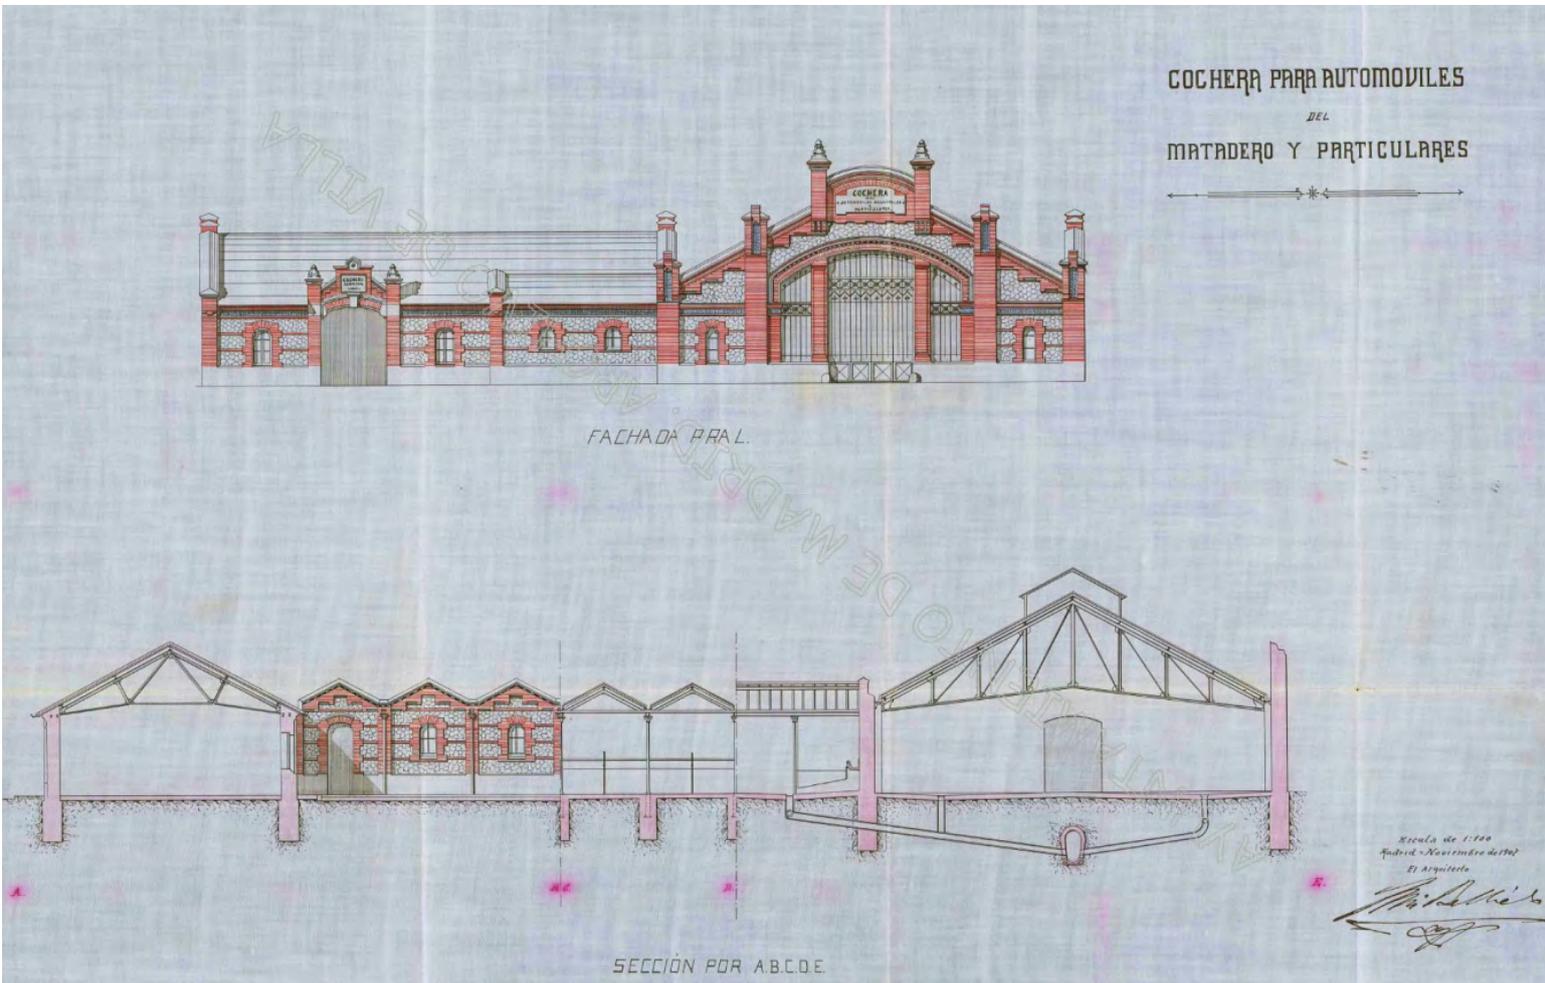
garagem, fachada e secção ABCDE. Imagem: Archivo de la Villa, Madrid.
